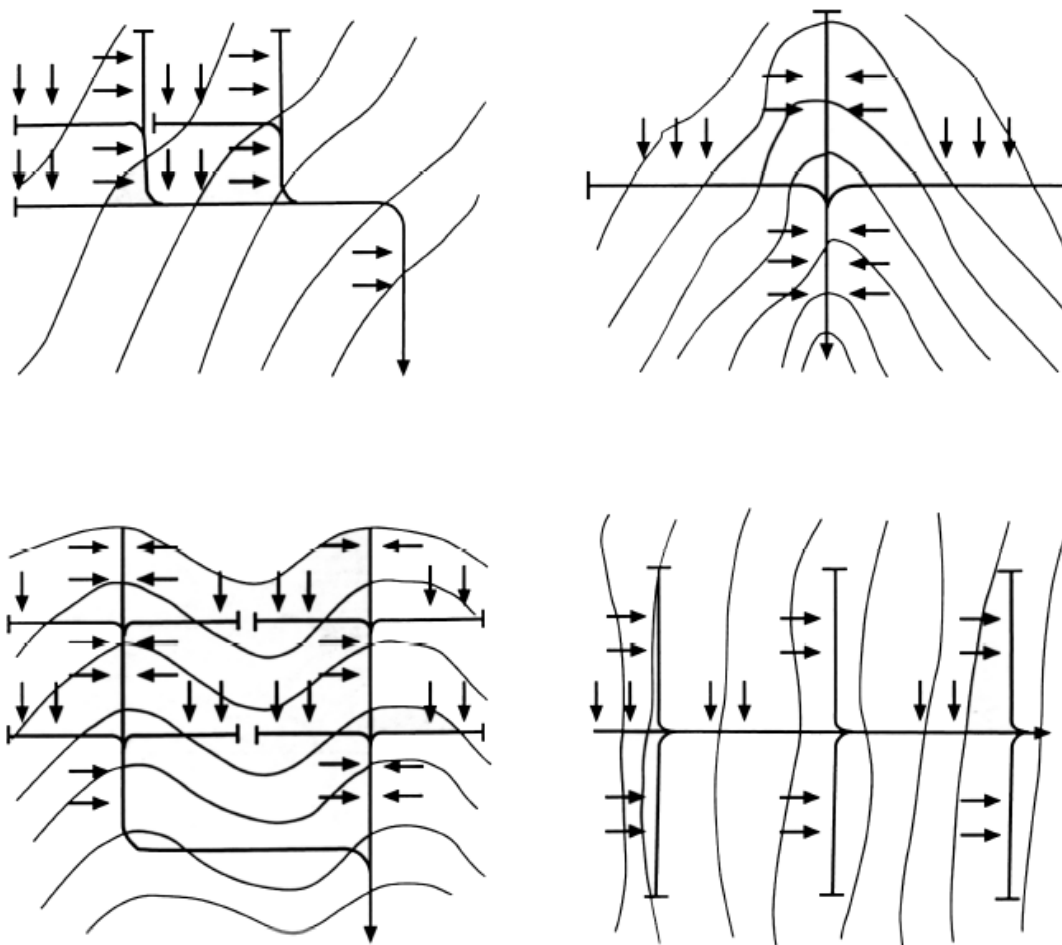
Alternativas de trazado de red de alcantarillado sanitario
